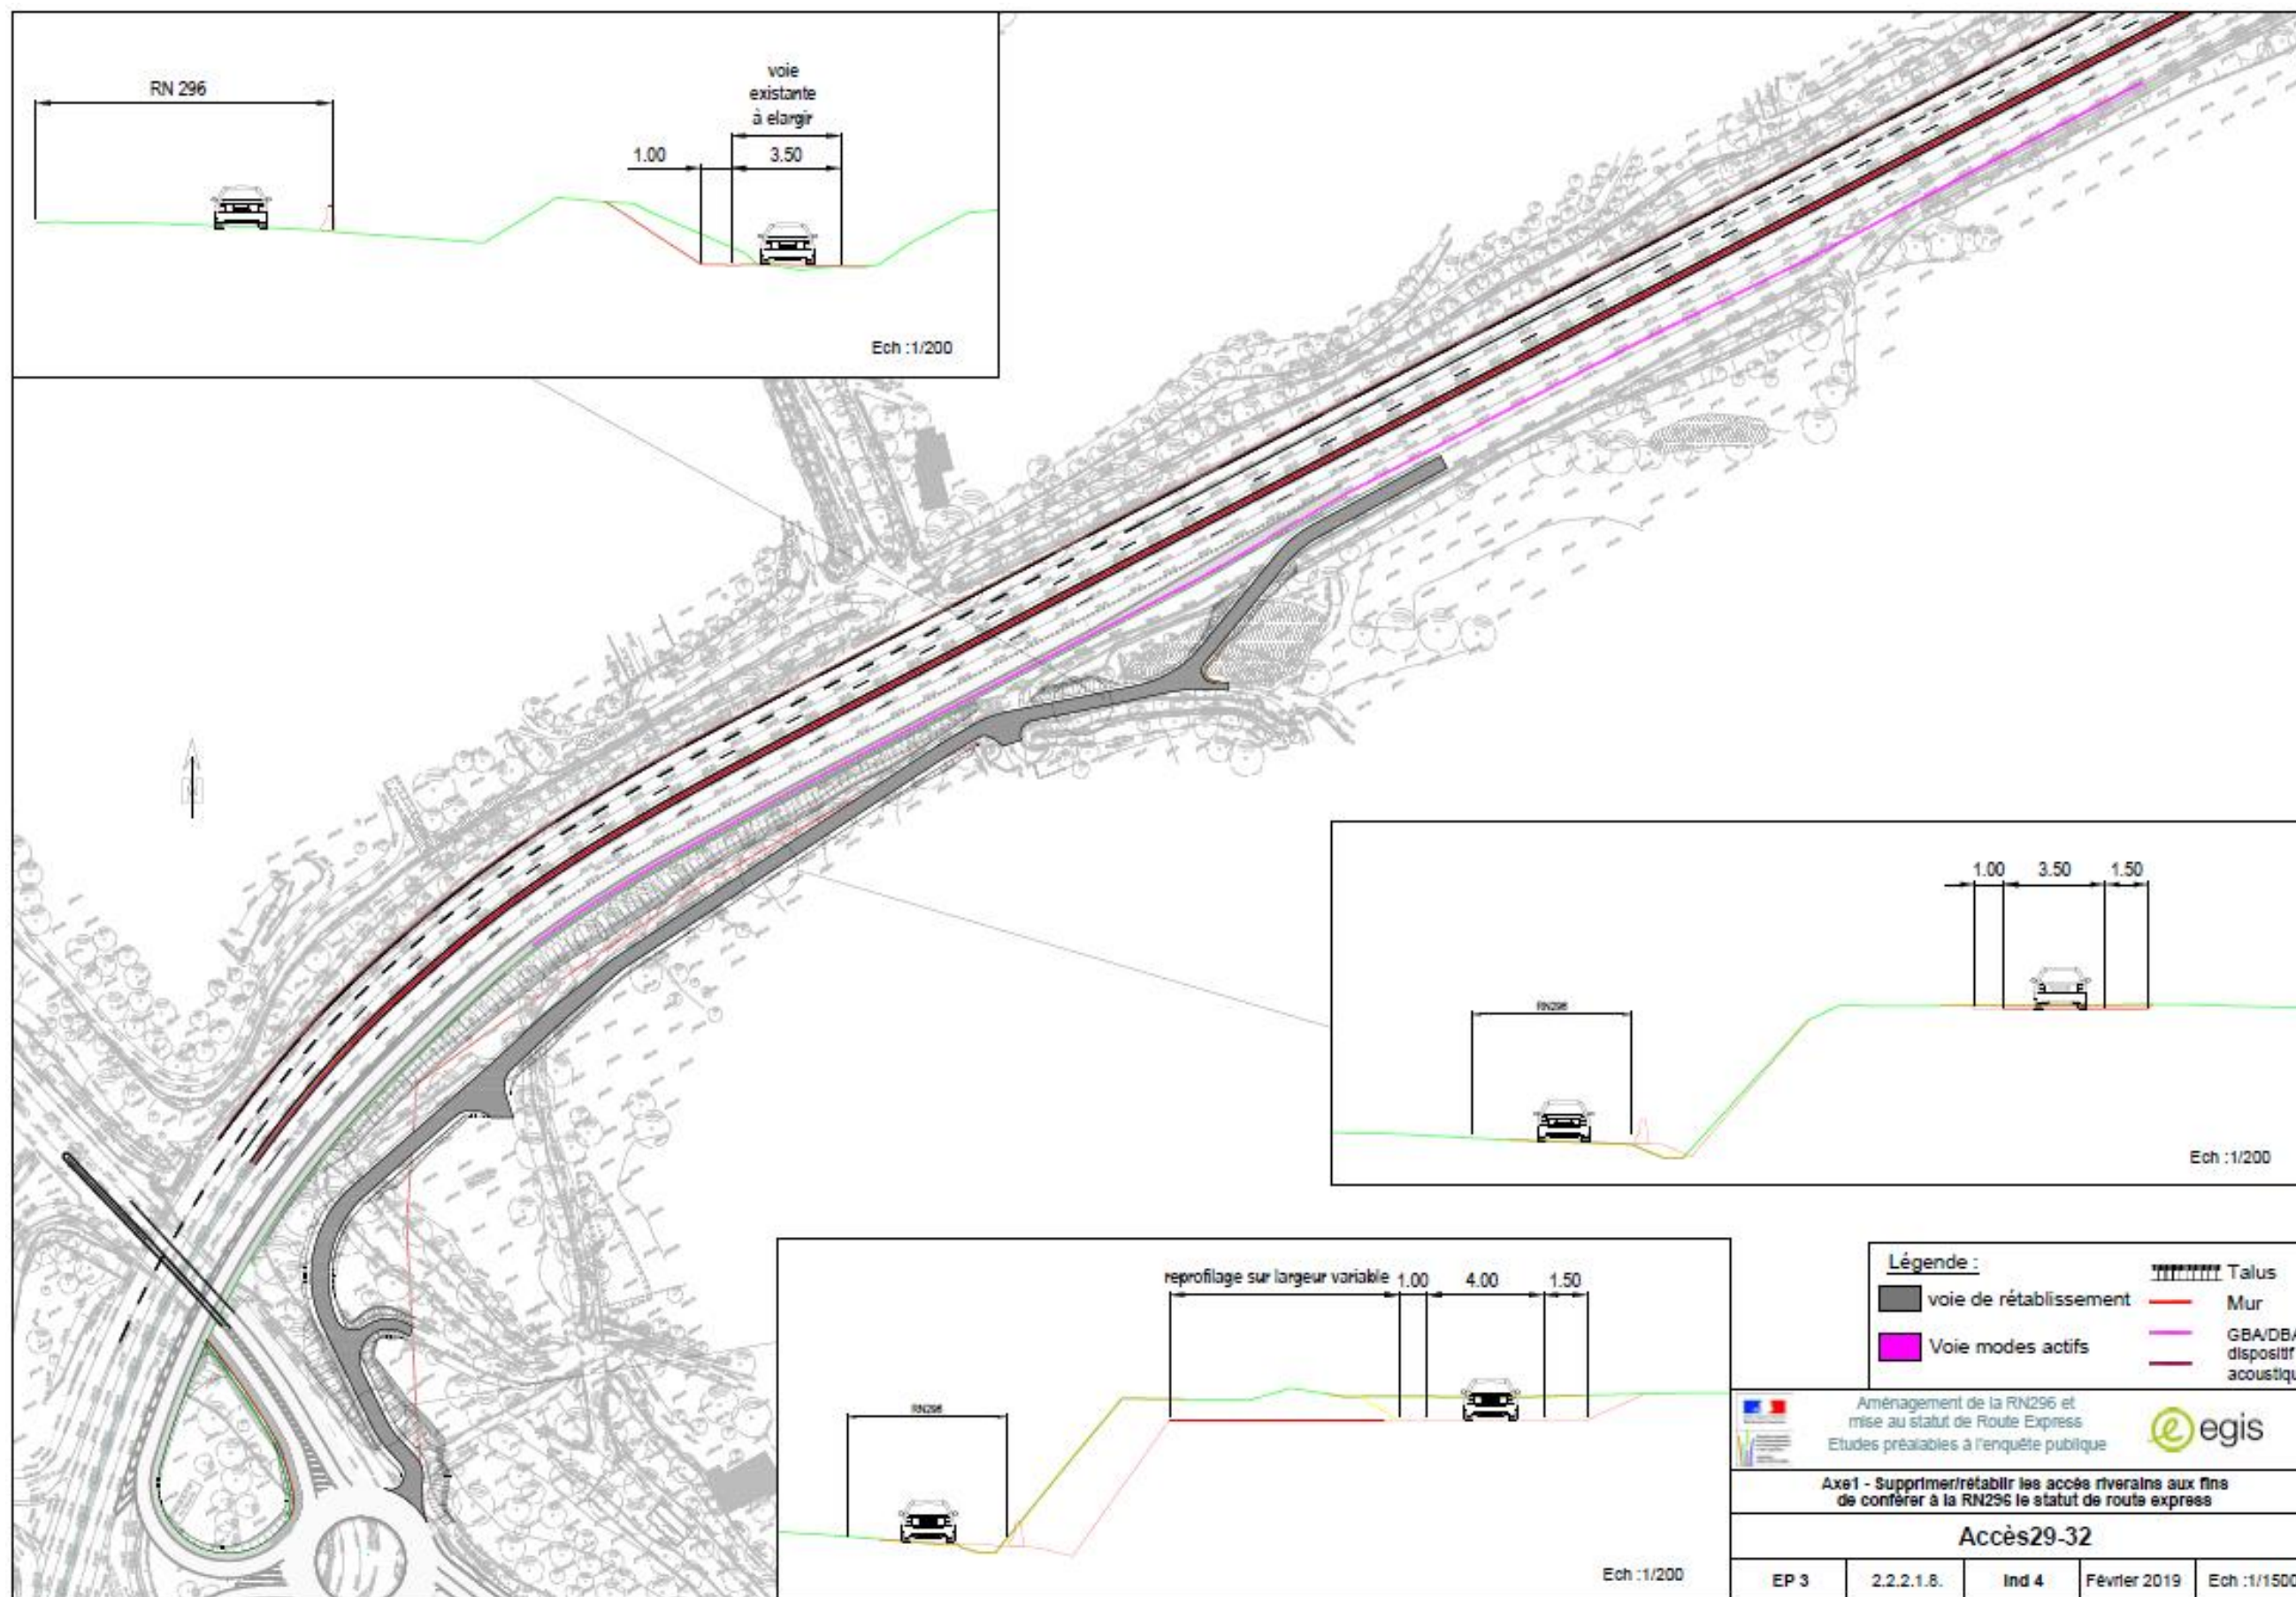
Profil en travers et vue en plan du réaménagement des accès 29 et 32
